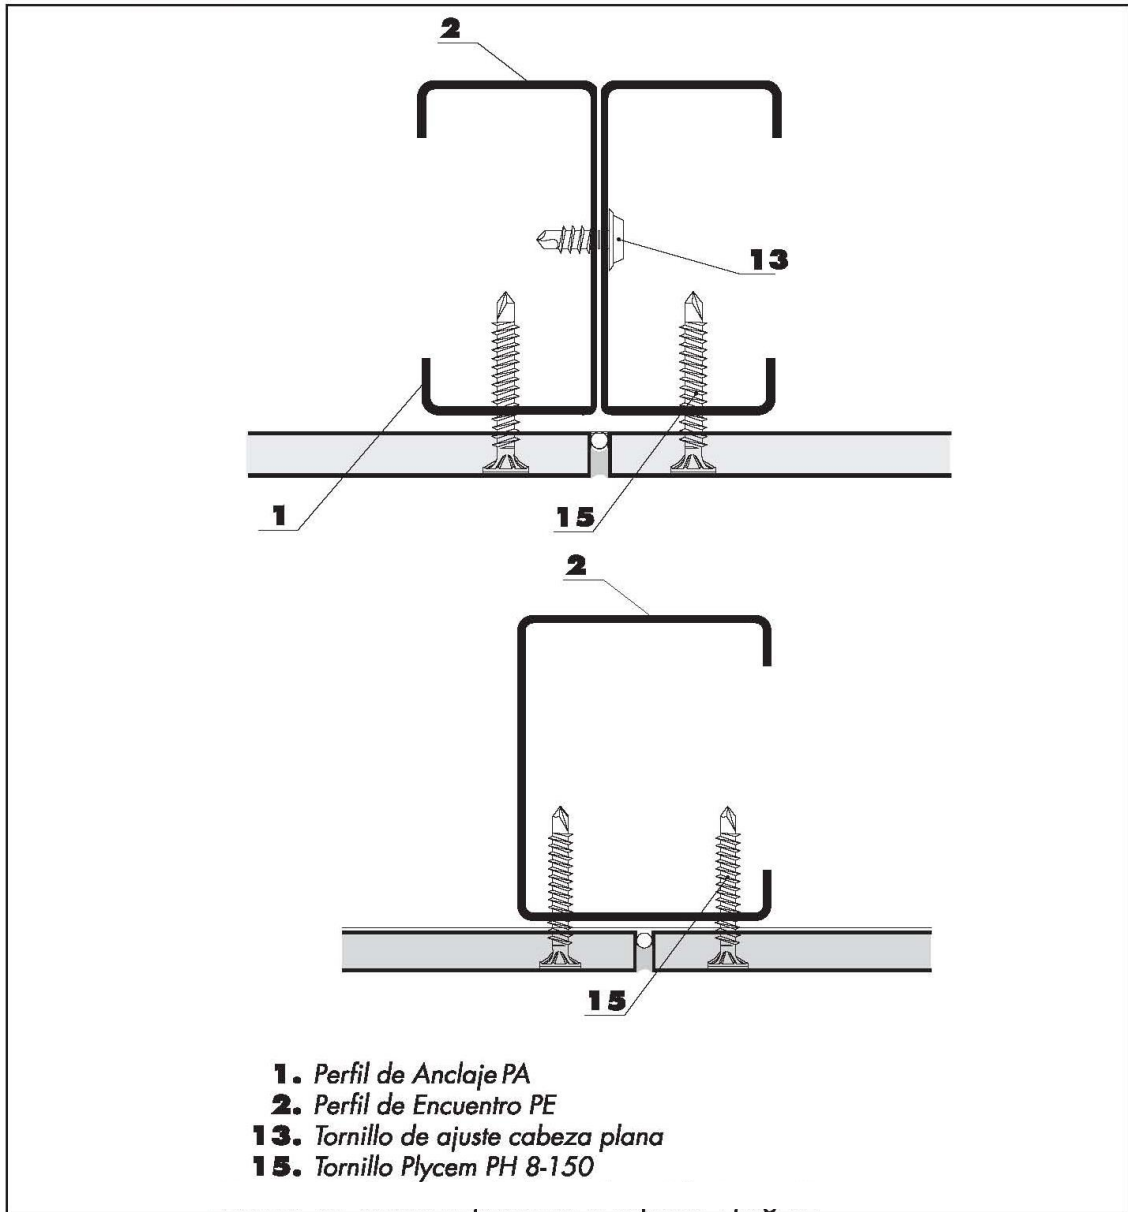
Detalle 9. Paredes exteriores. Tipo de juntas. Junta flexible [87].
